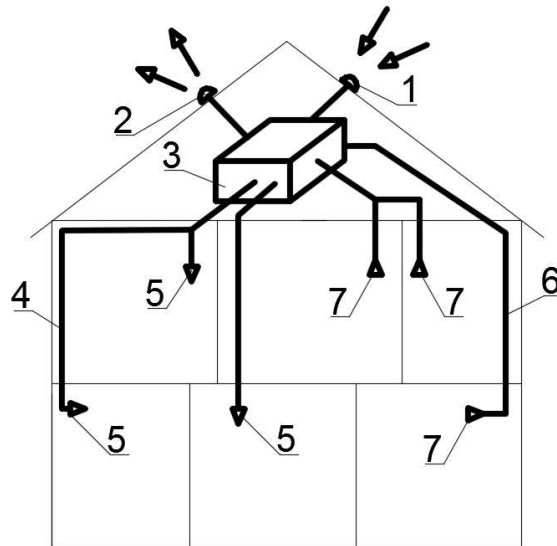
Конструктивна схема припливно-витяжної вентиляції будівлі: 1 – повітрязабірний пристрій; 2 – витяжний пристрій; 3 – припливно-витяжна установка з рекуператором; 4 – припливний повітропровід; 5 – повітророзподільна ґратка; 6 – витяжний повітропровід; 7 – витяжна ґратка
